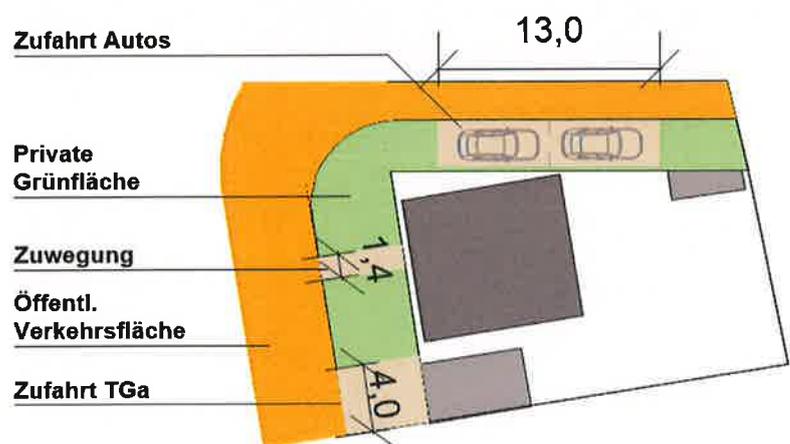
Überdeckung der Grünflächen (Vorgarten) – Maximal zulässige Breite an der Putzbrunner Straße und Ottostraße
